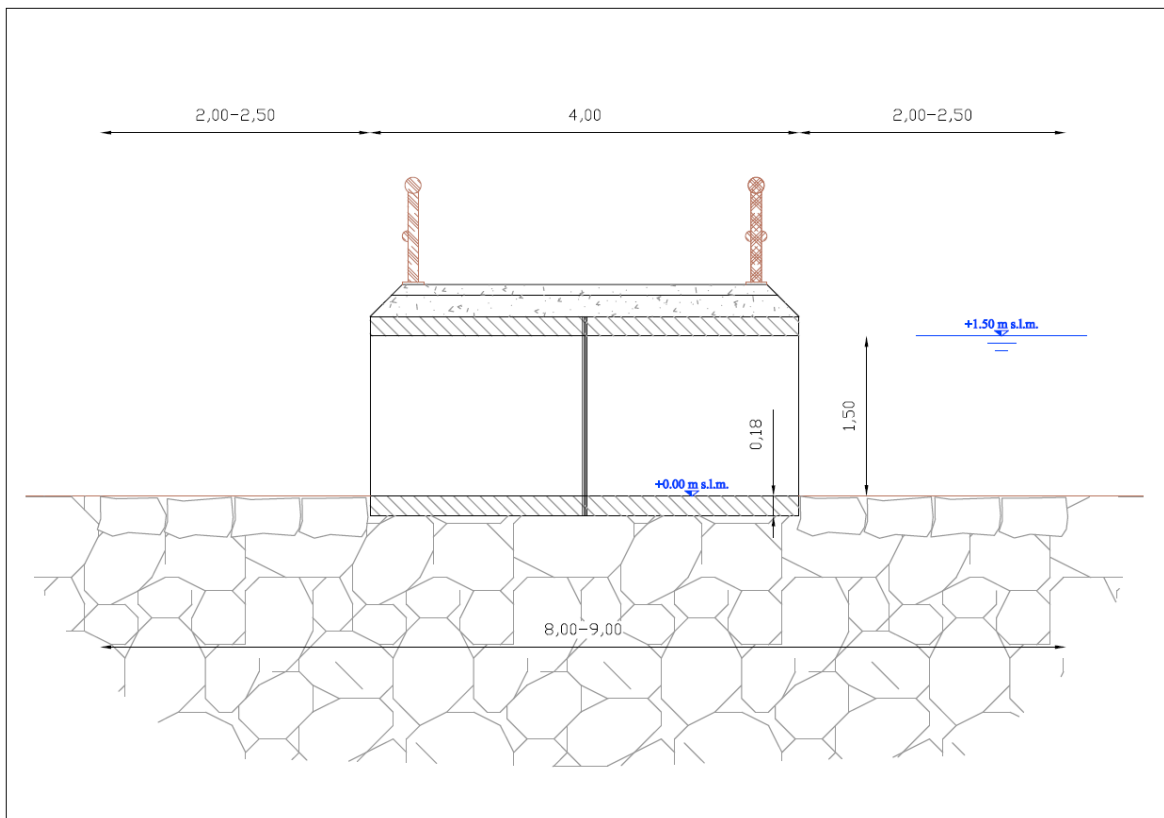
Vista particolare sezione del guado in alveo – andamento teorico delle linee di flusso.
